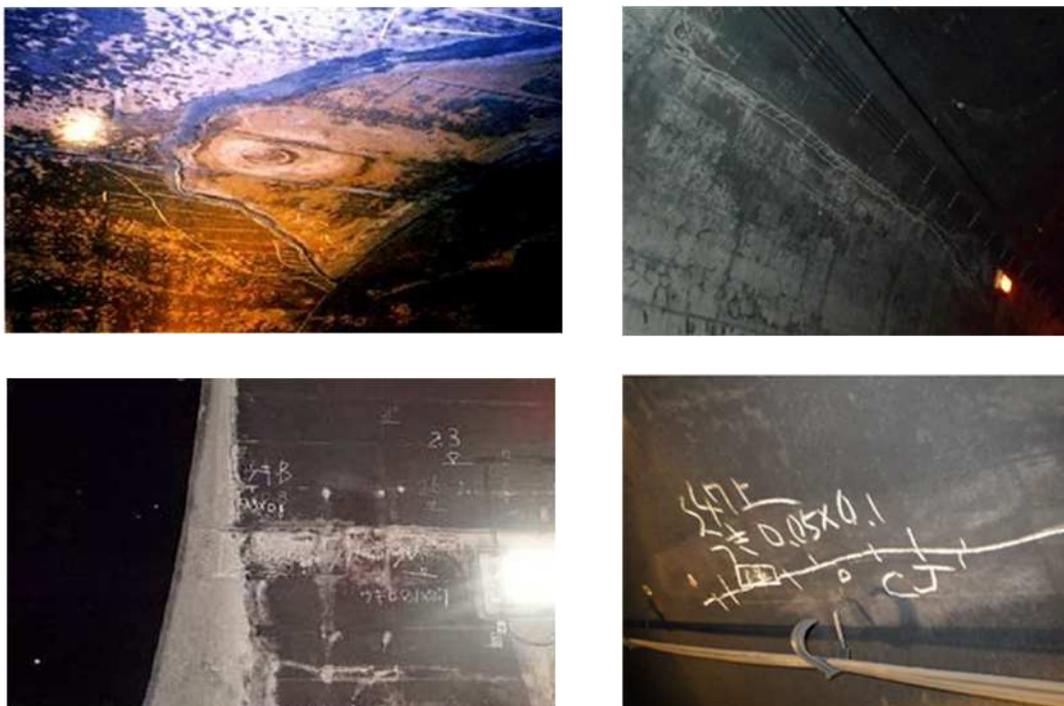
コールドジョイント付近に発生したひび割れの例¹⁾
